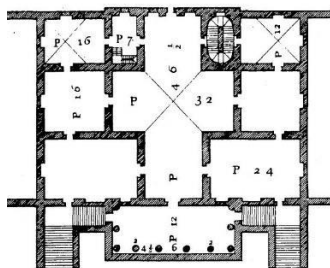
Planta da Vila Malcontenta Fonte: STINY G.; MITCHELL W. J., 1978, p. 6.
